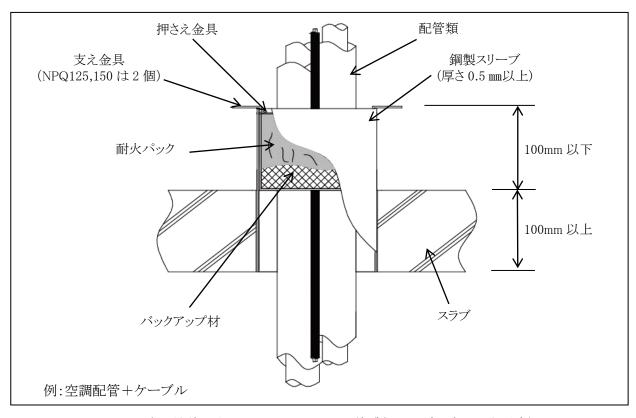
床工法施工断面図:PS060FL-0734(鋼製スリーブが突き出す場合)
